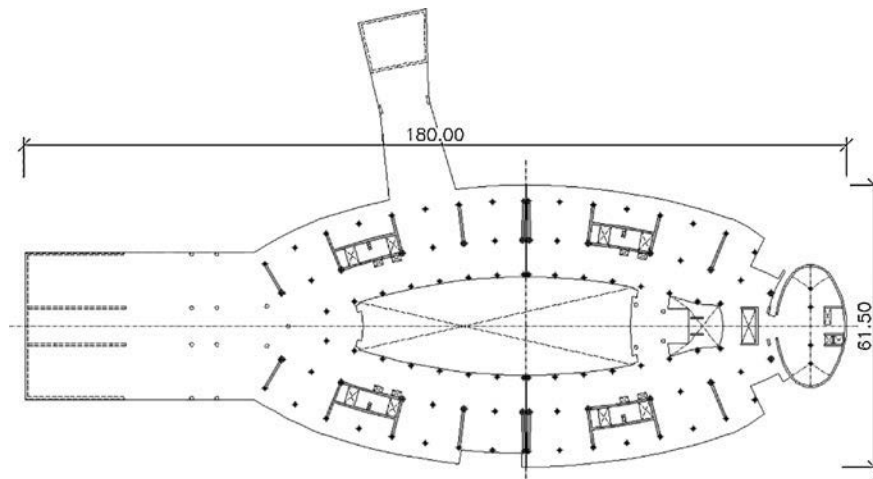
Estación Bir Mourad Rais (Argel). Planta +1.
